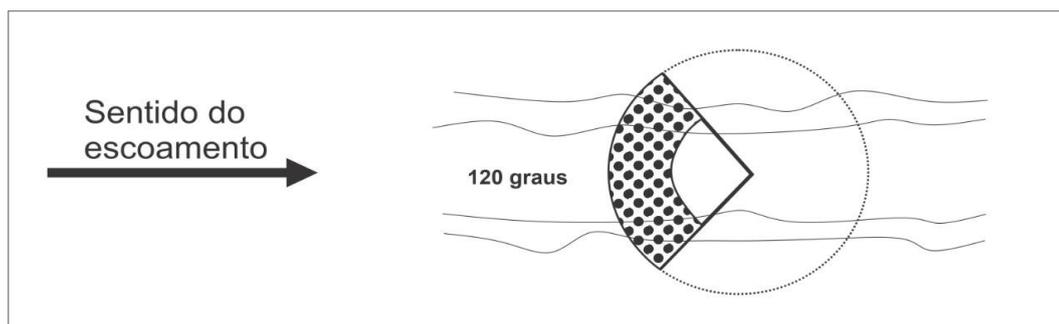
Planta baixa de uma barragem de contenção de sedimentos.
